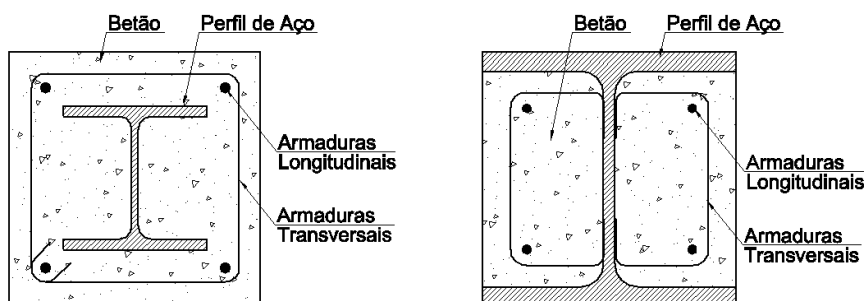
SECÇÃO TOTALMENTE BETONADA (ESQ.) E SECÇÃO PARCIALMENTE BETONADA (DIR.)
